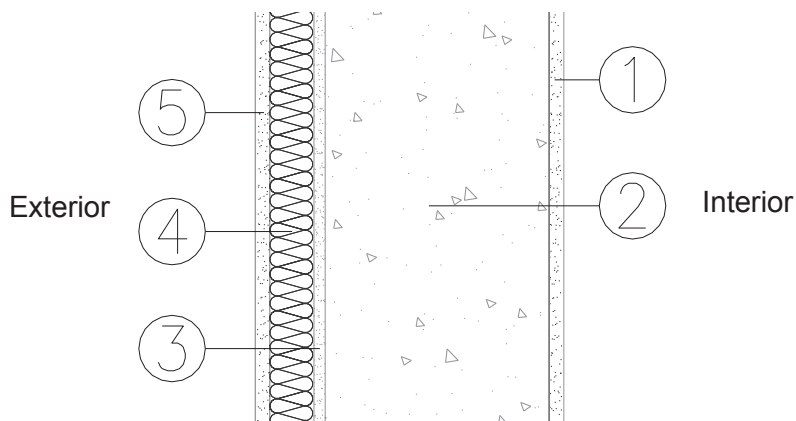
Ponte Térmica Plana de Pilar/Viga Interior
